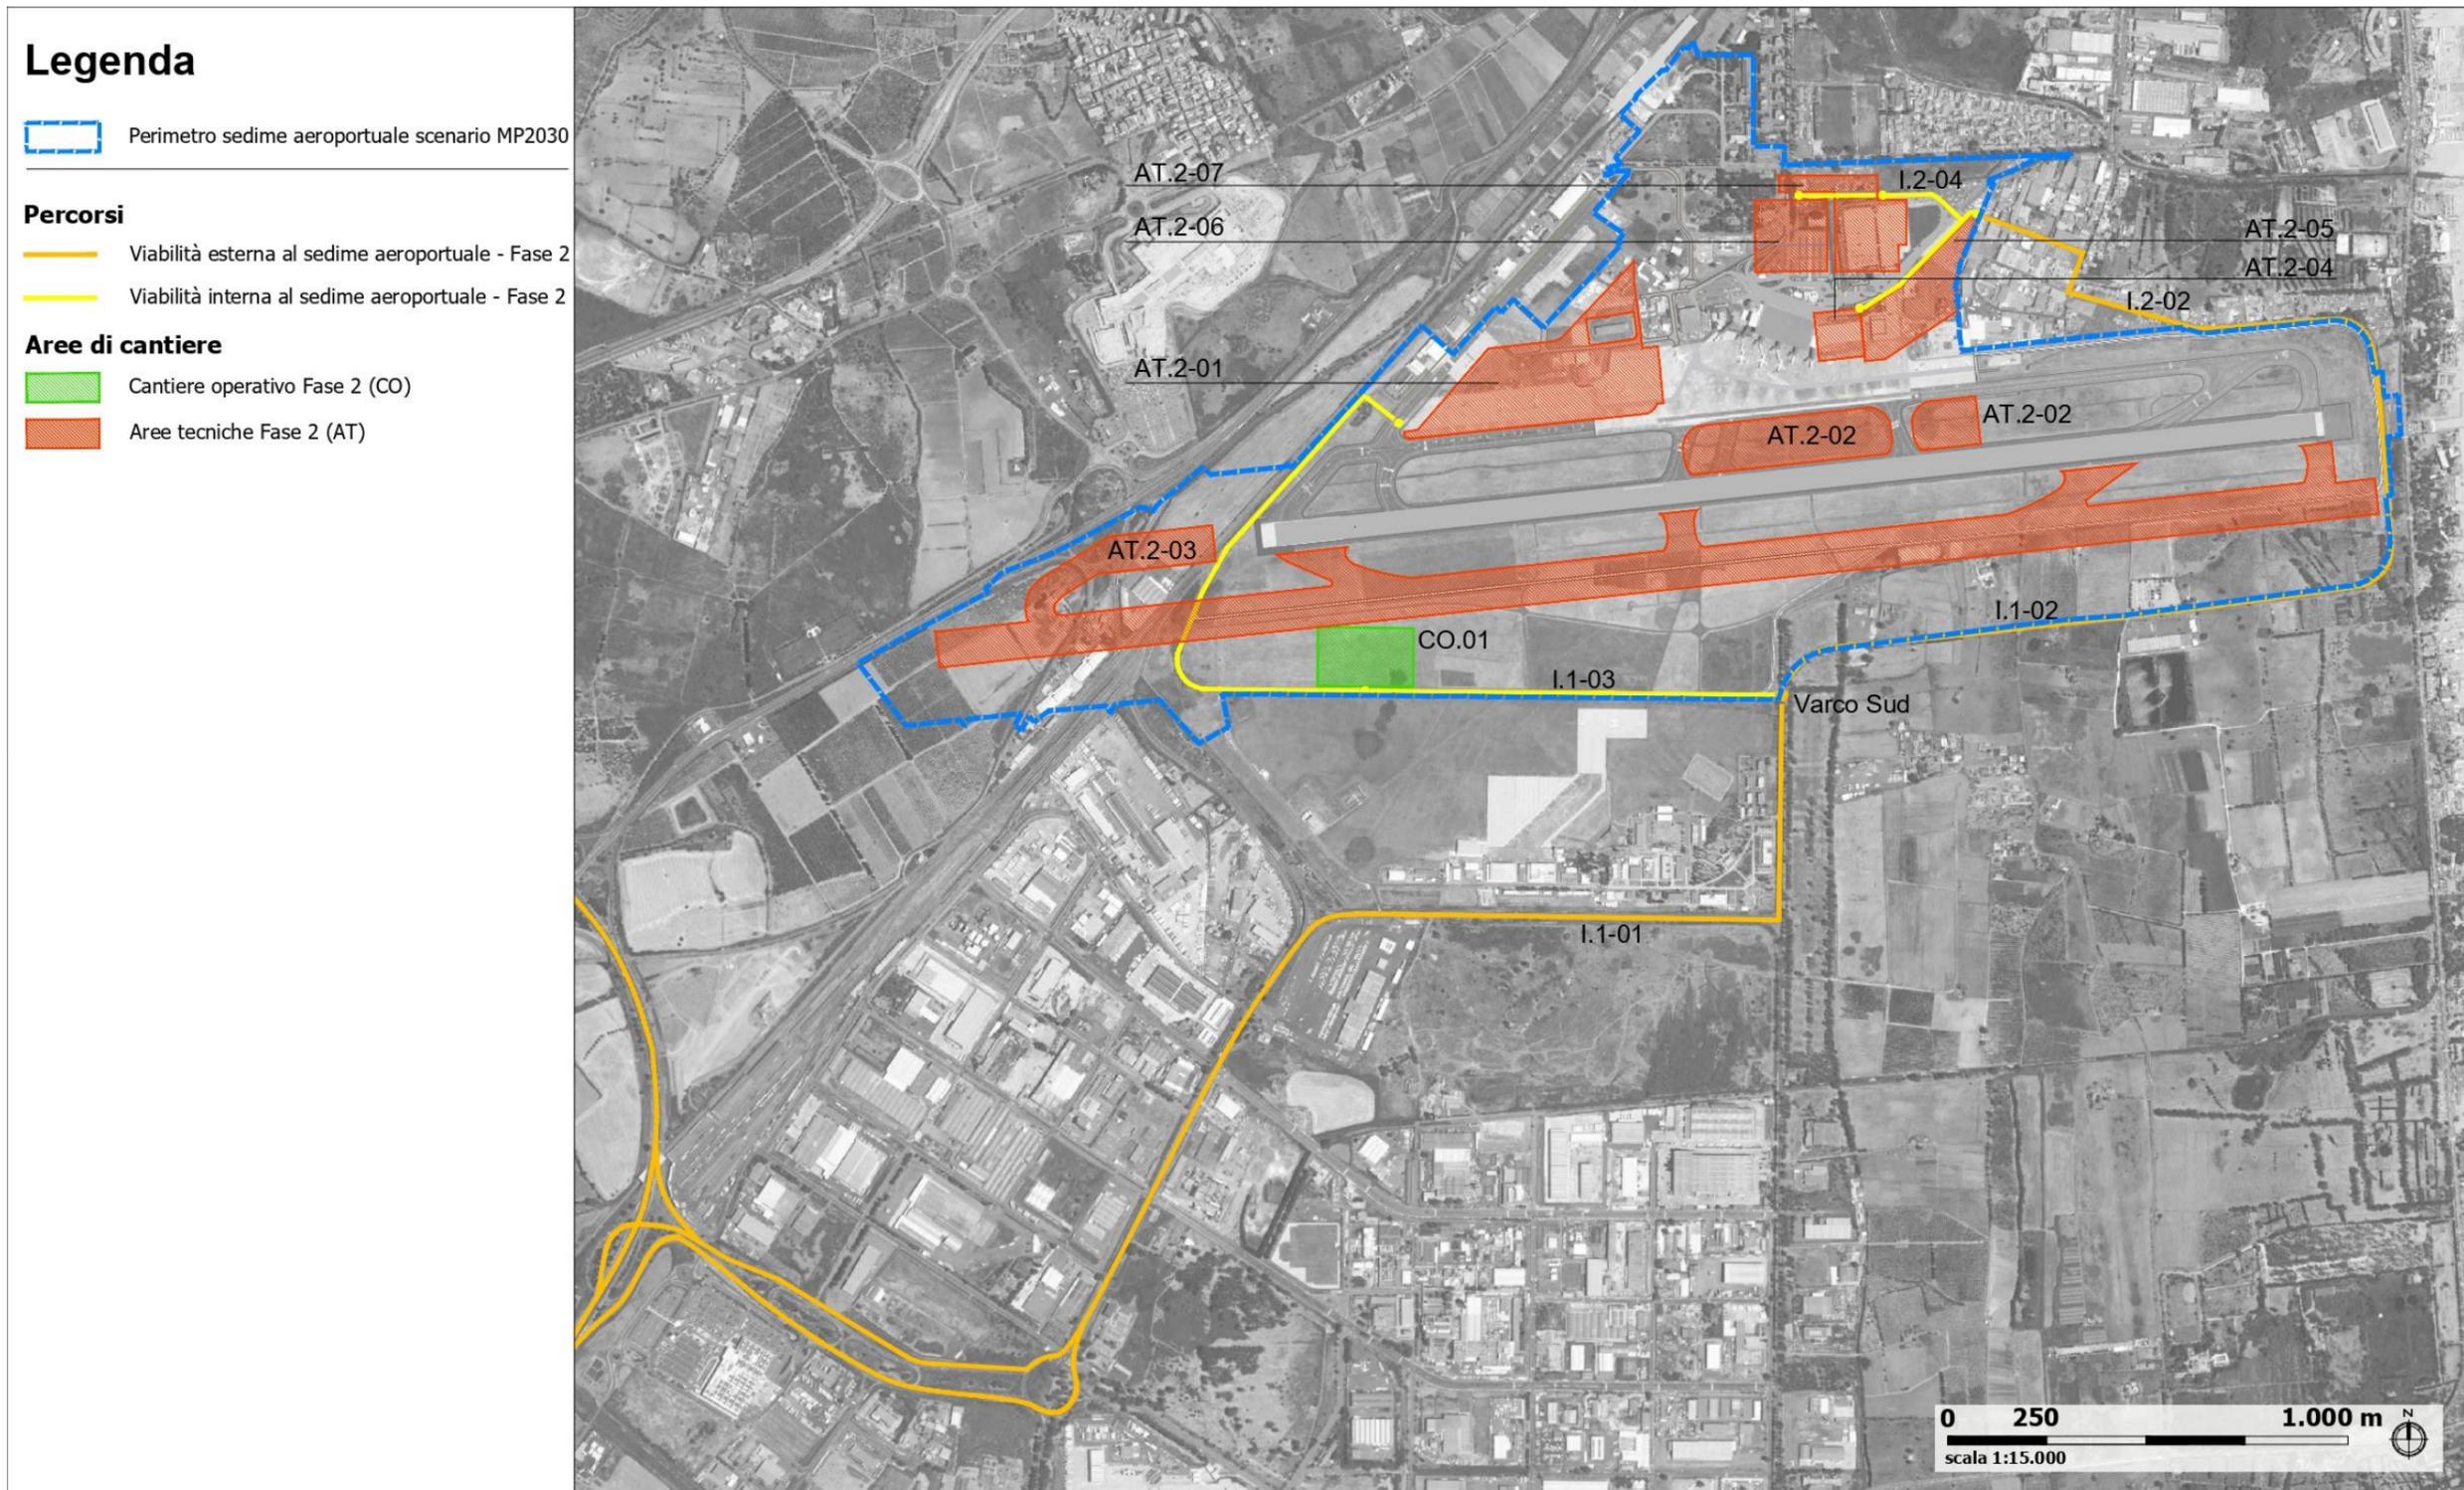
Planimetria delle aree di cantiere di Fase 2
